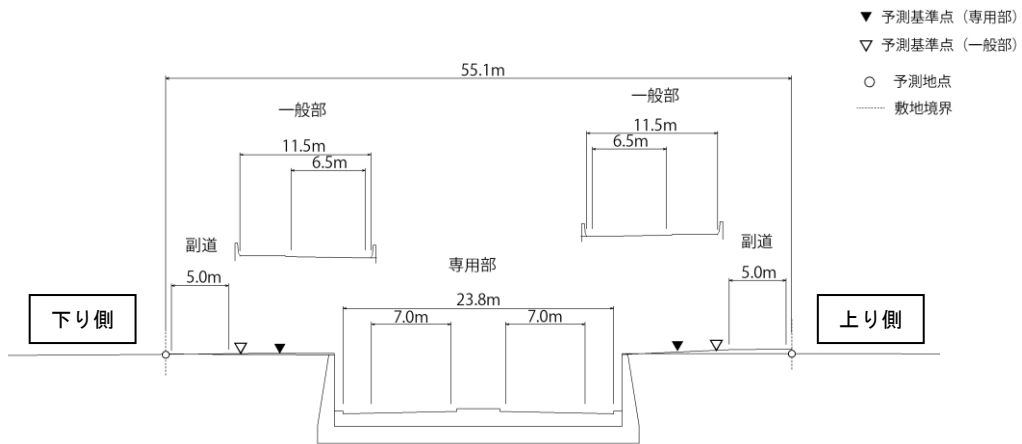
(8) 予測断面図 (8. 鎌ヶ谷市初富(1))
